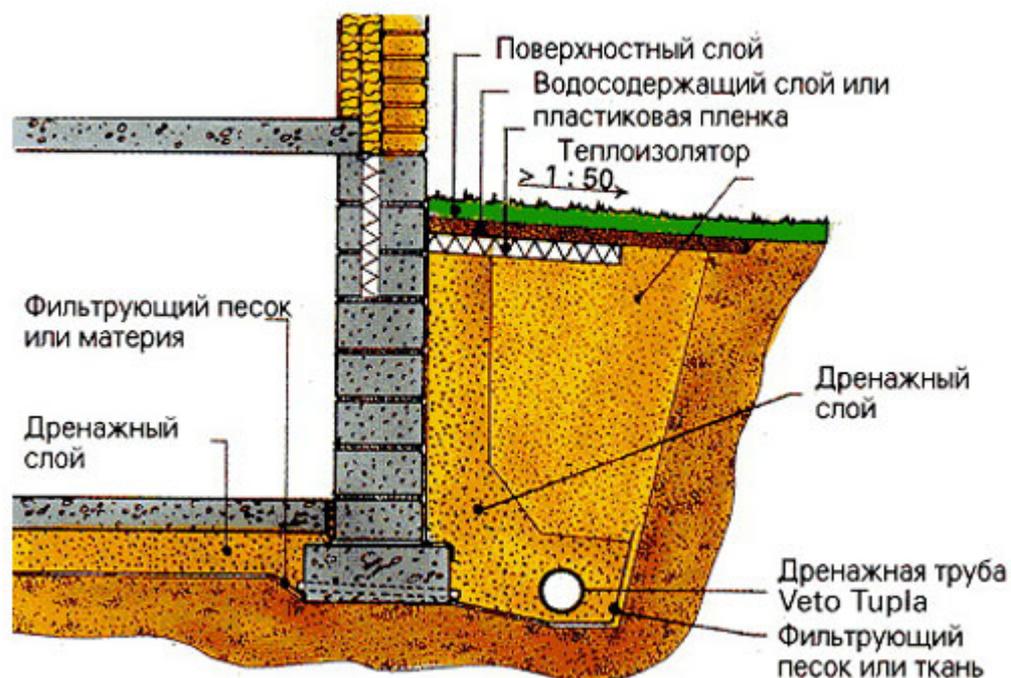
Комплексная защита фундамента от пучения грунта
